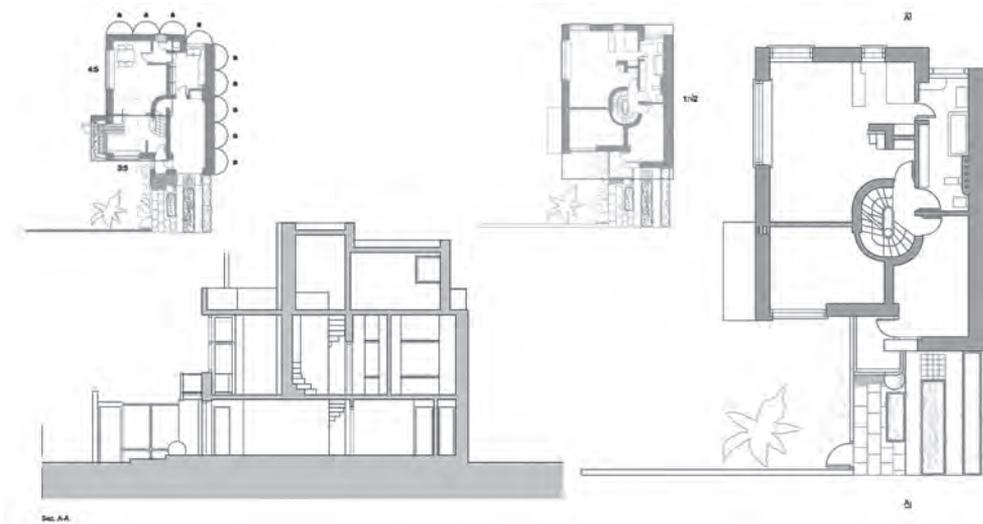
Ridisegno della pianta del primo piano, sezione longitudinale e rapporti armonici.
